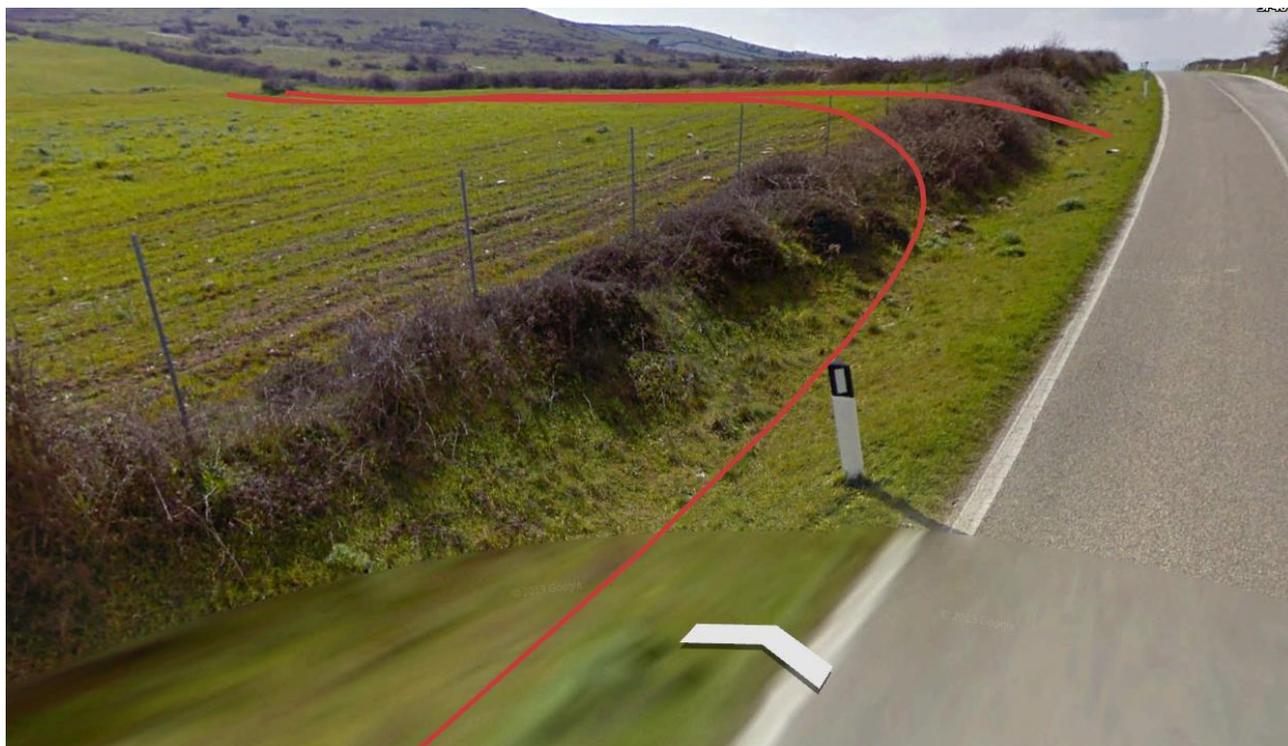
Accesso della pista di collegamento della postazione BAP6 dalla SP40
